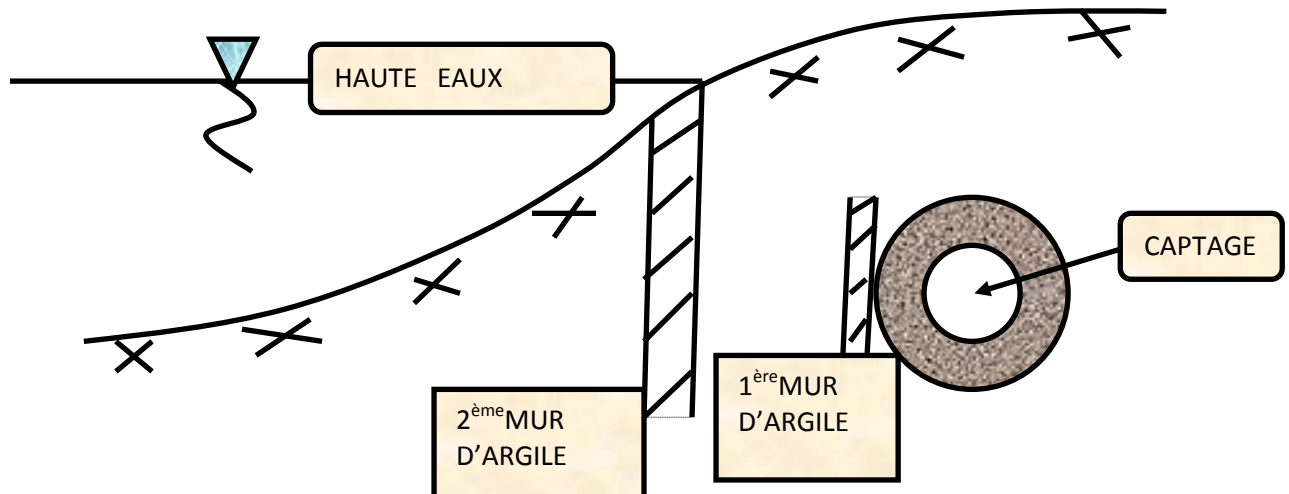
FIGURE.VII. PROTECTION DU CAPTAGE SOUTERRAIN
